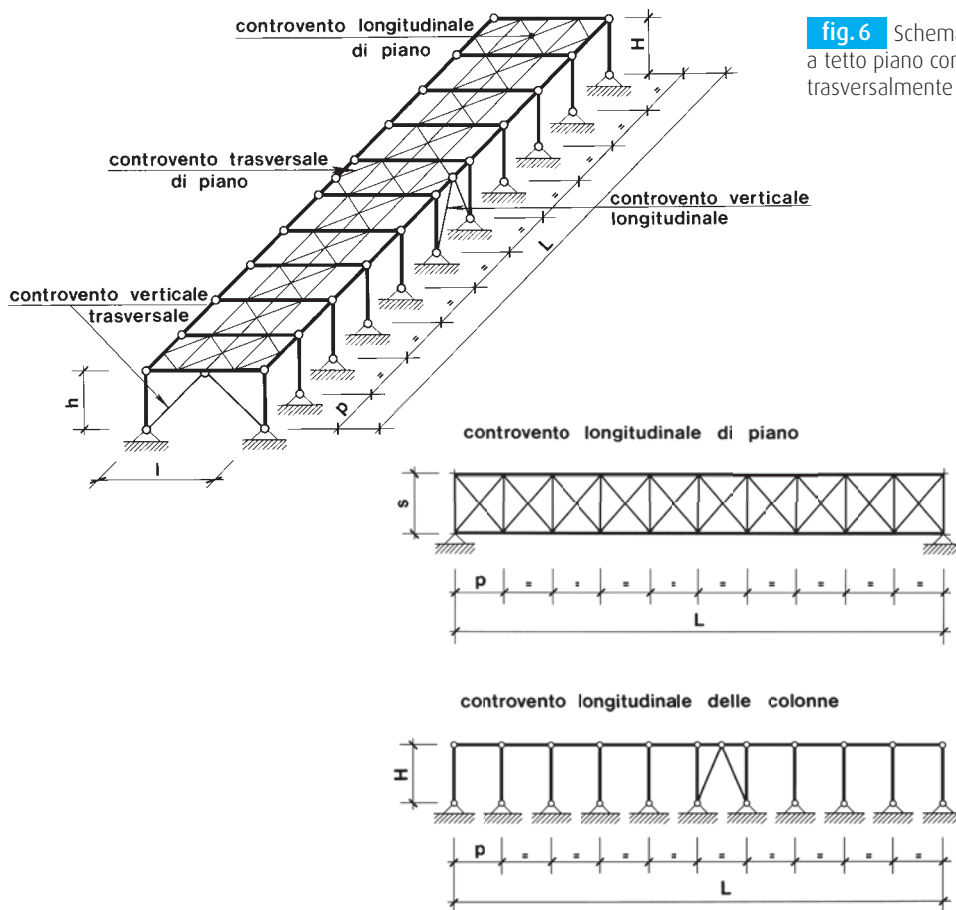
Schema statico di un fabbricato monopiano a tetto piano con colonne incernierate alla base trasversalmente e longitudinalmente.
